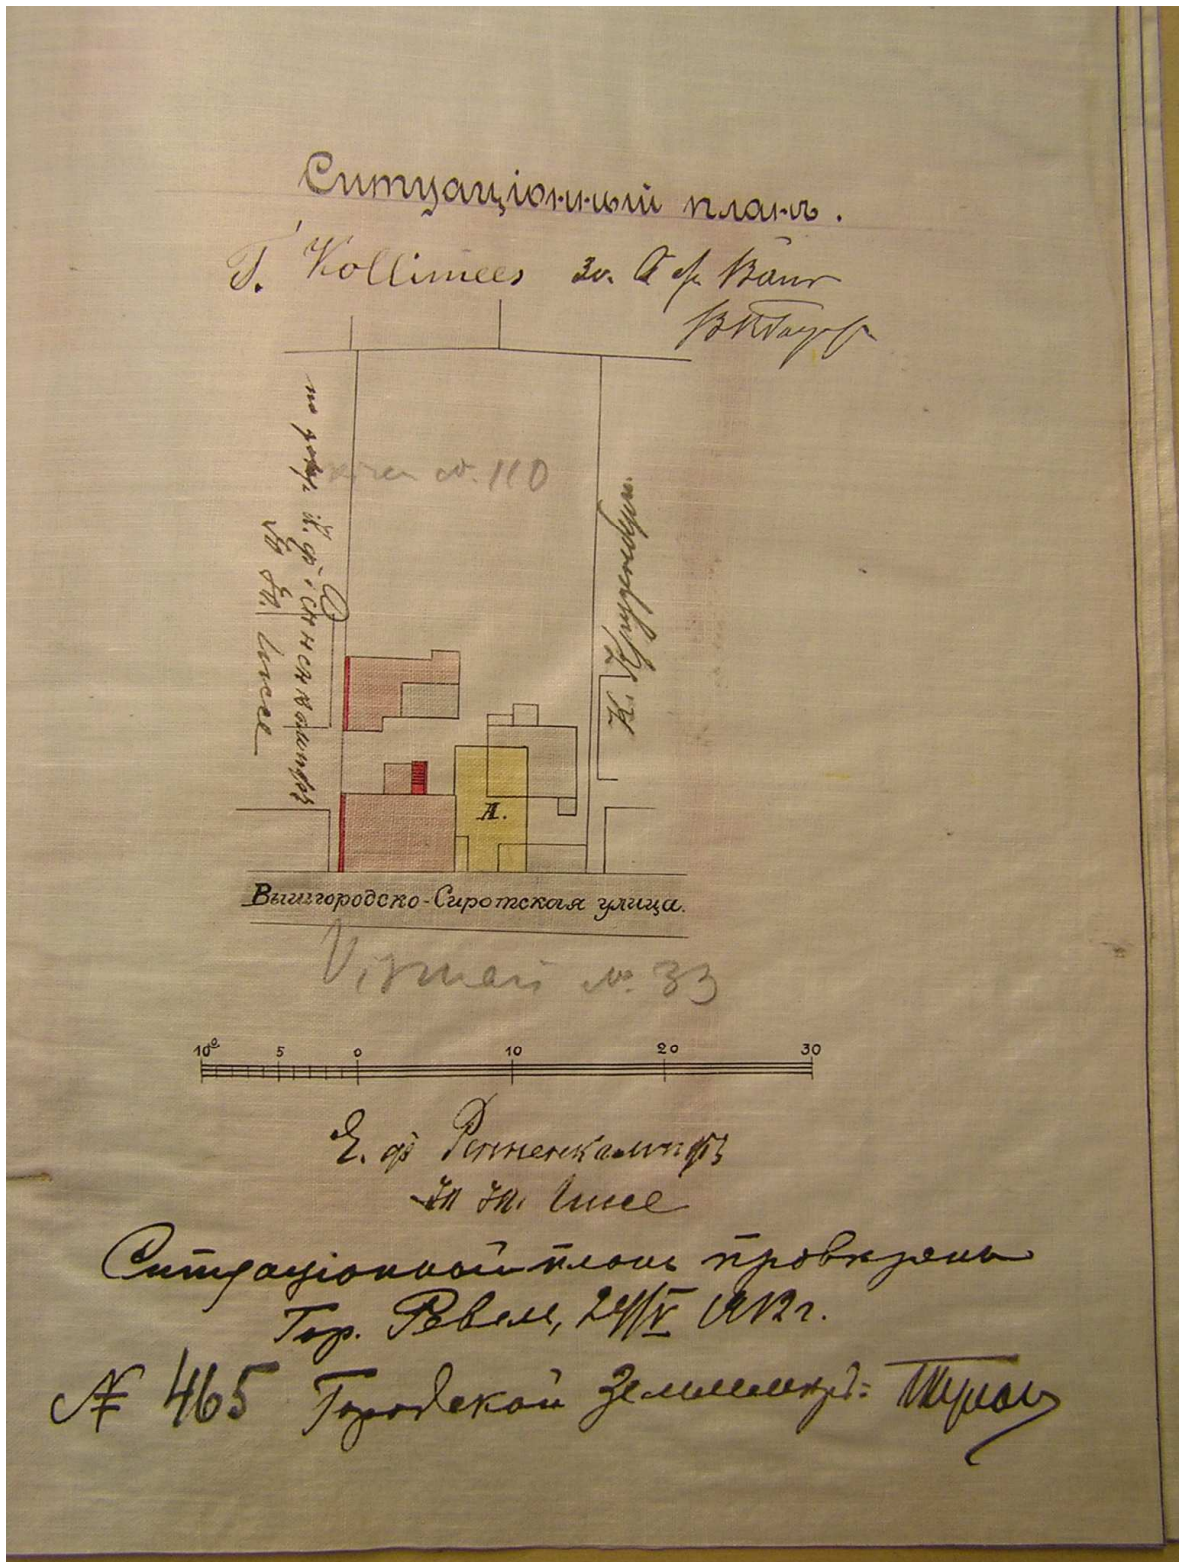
juurdehituse asendiplan, 1912. a – foto arhiividokumendist
